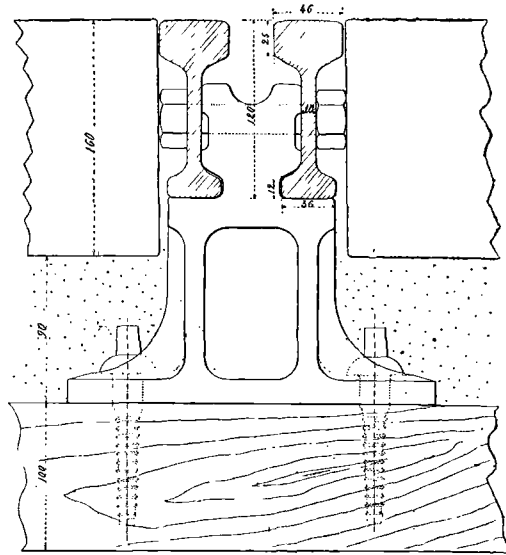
Coupe transversale de la voie Marsillon (Paris).
